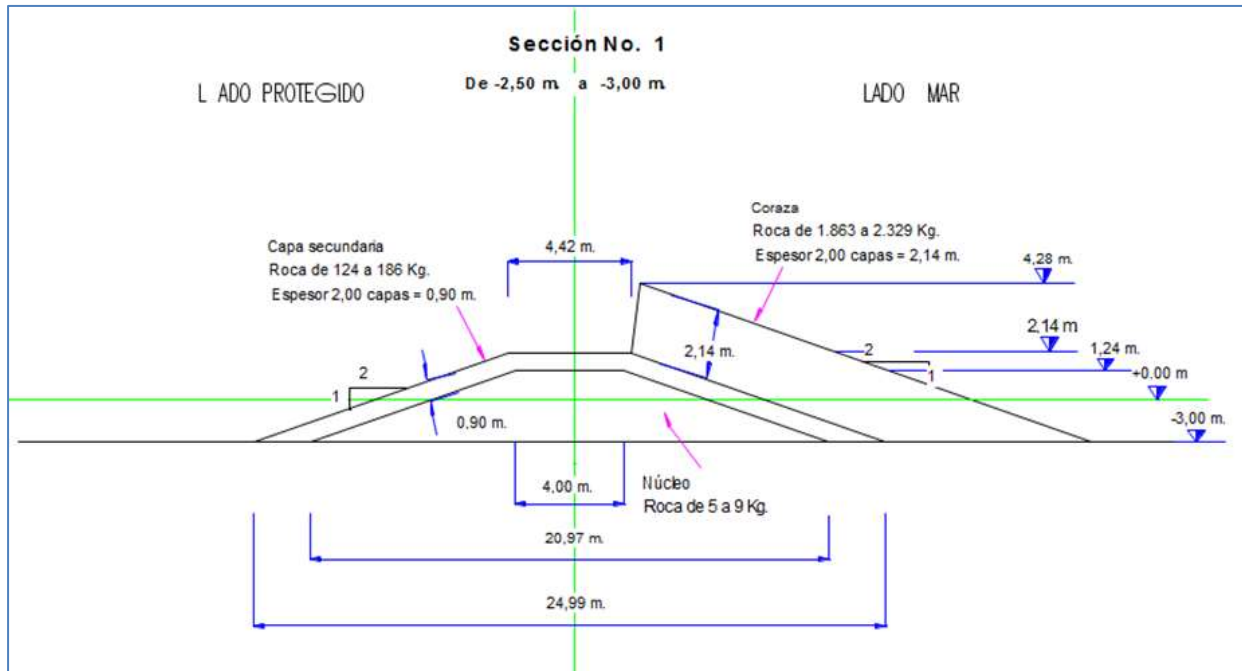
Sección tipo del rompeolas con elementos de enrocamiento
